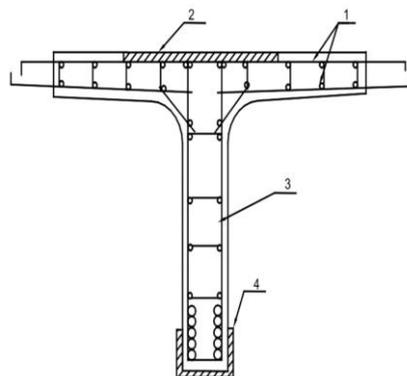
Усиление железобетонной балки приваркой плоского листа к плите и обоймы из швеллера к ребру: 1 – существующая арматура; 2 – лист усиления; 3 – усиливаемая балка; 4 – швеллер (обойма)
